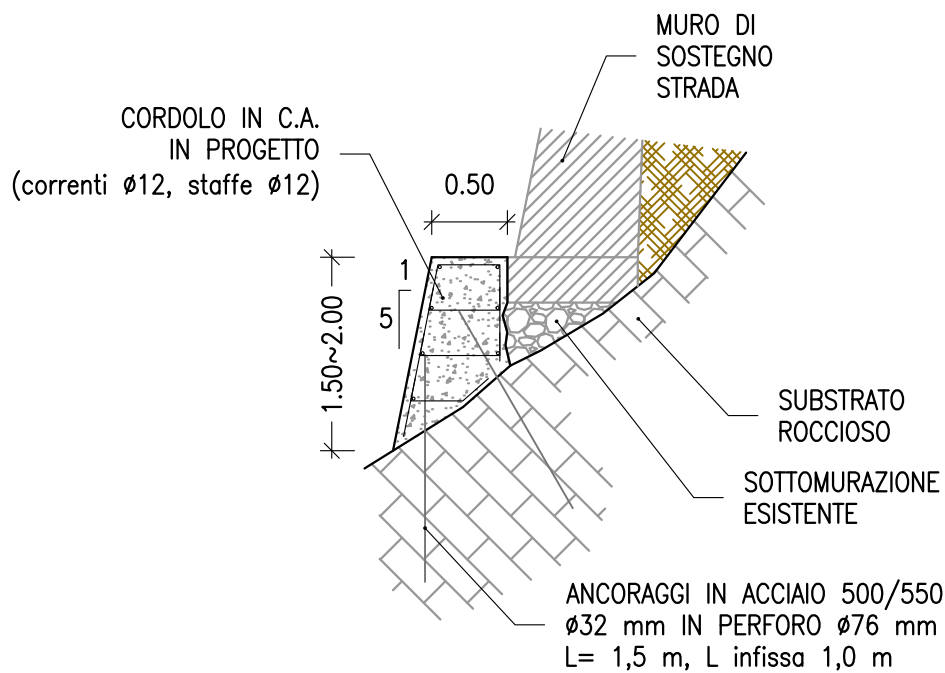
Sezione tipo sottomurazione con cordolo in C.A.
